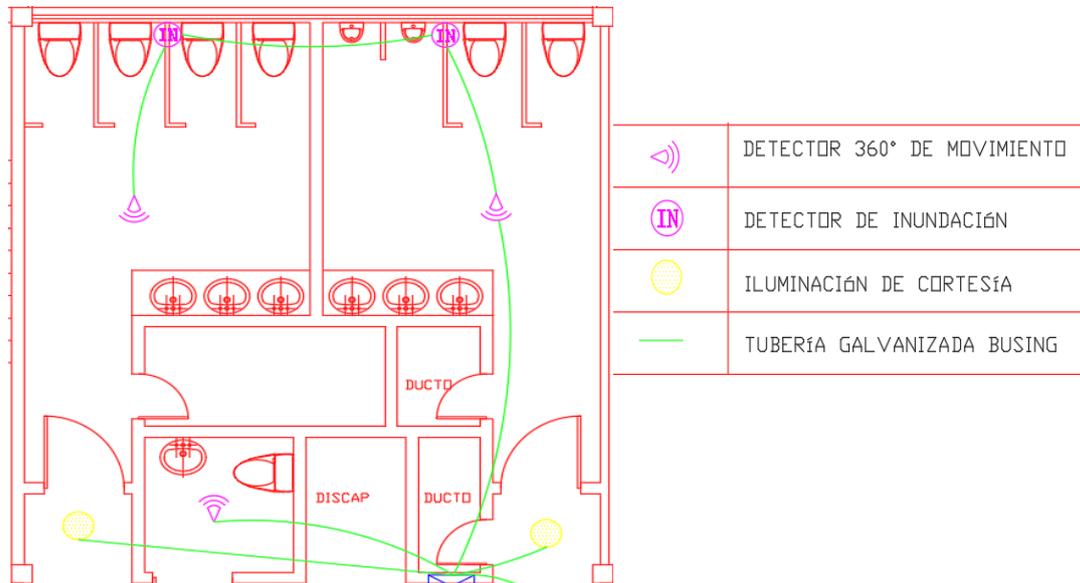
Arquitectura del sistema Inmótico de las áreas comunes de la planta baja
